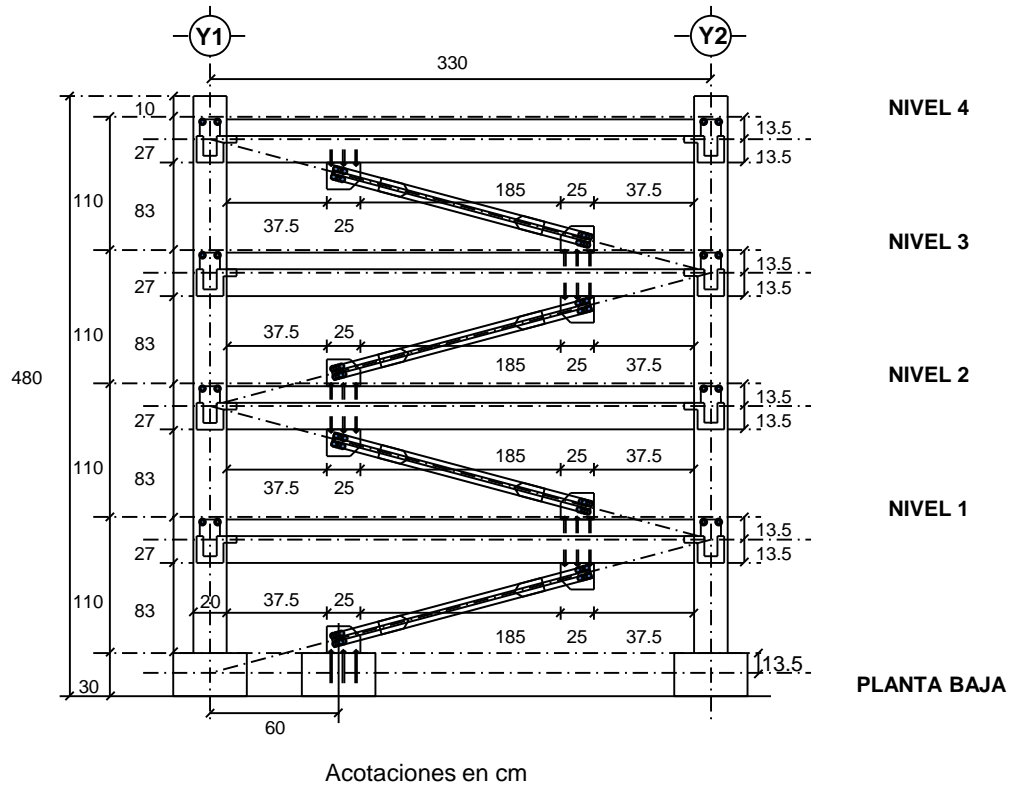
Vista en elevación de los marcos de la dirección longitudinal
